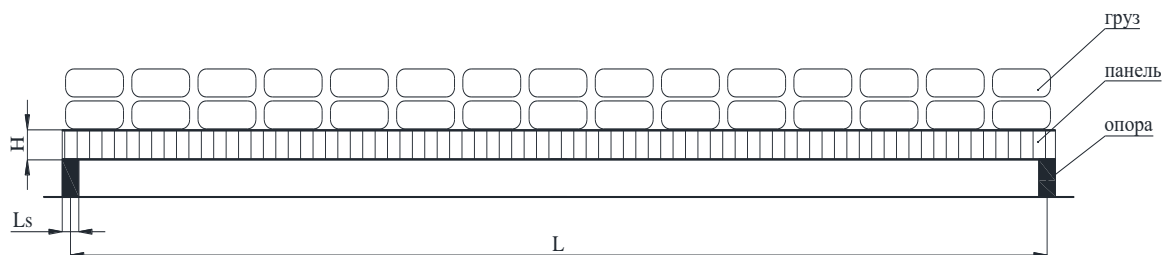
Схема натуральных испытаний для однопролетной панели
